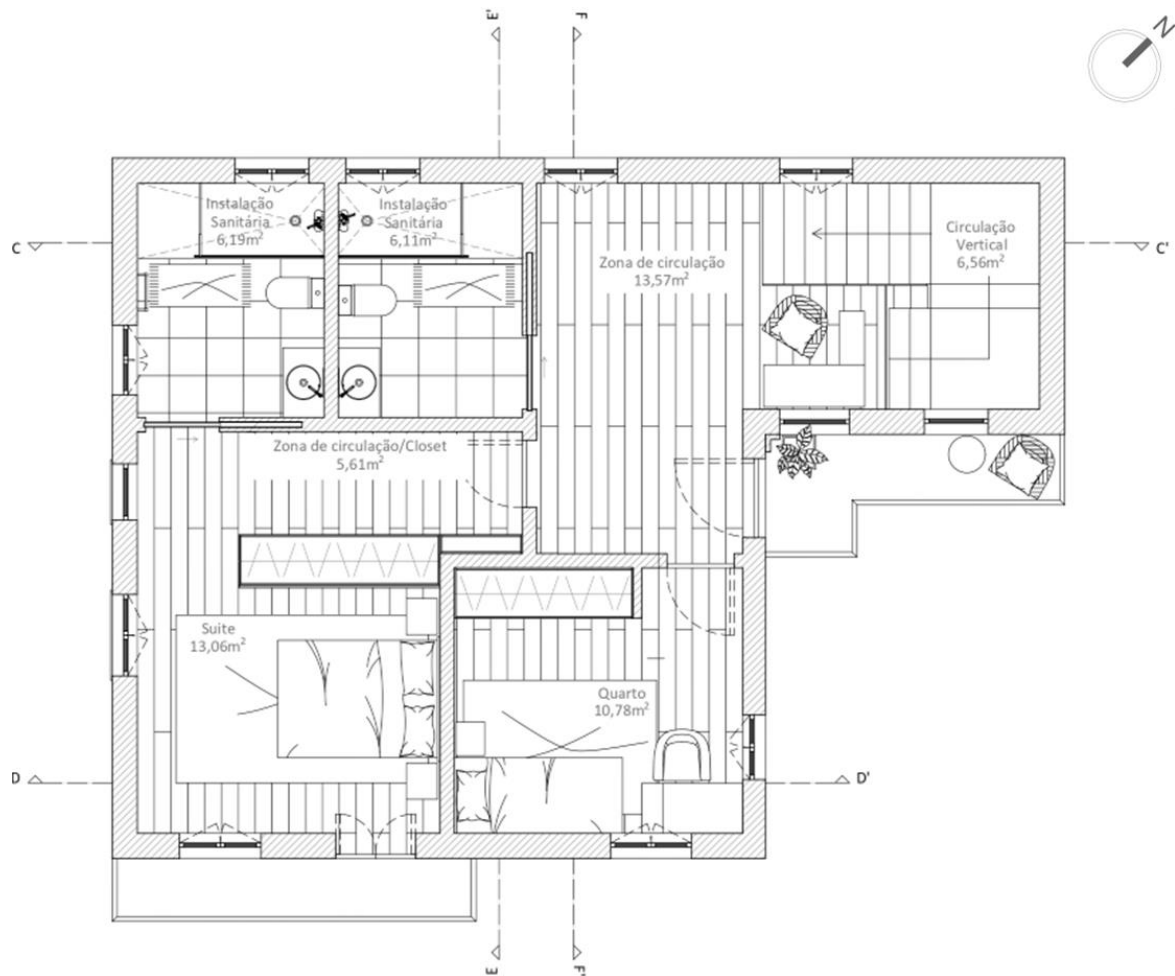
Planta de Apresentação do piso 1. Fonte: Autor
